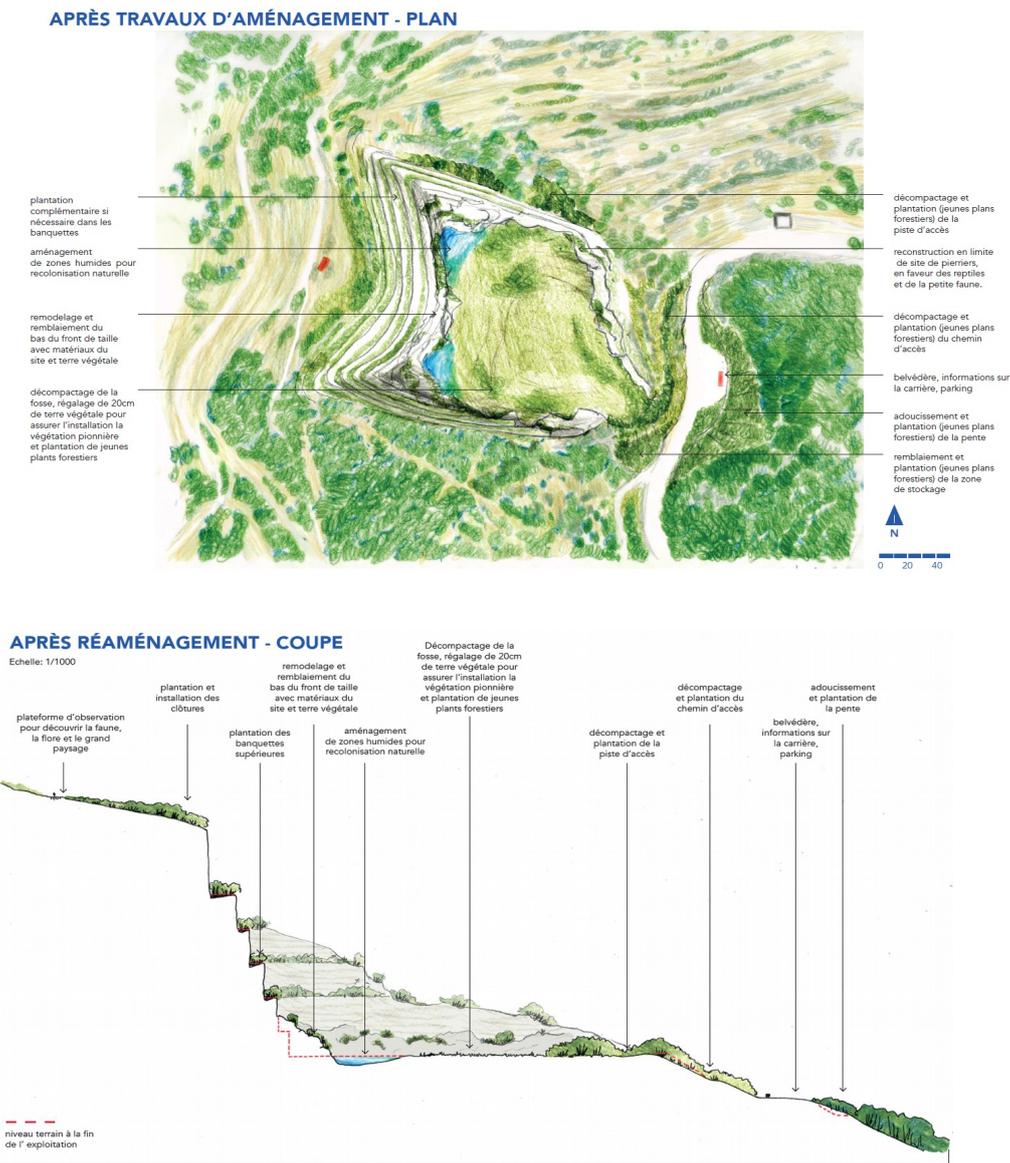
Plan des aménagements du site après travaux (source Amaury Dubois Paysage – Atelier De Paysage)
